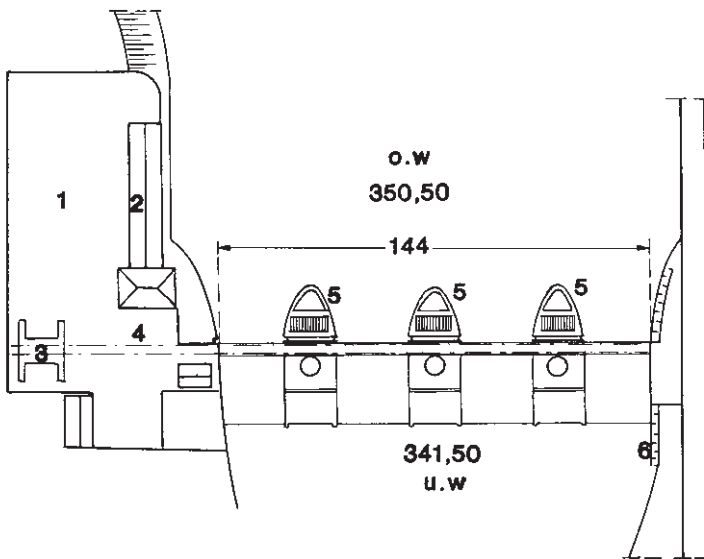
Grundriss des Pfeilerkraftwerks Lavamünd an der Drau/Österreich
